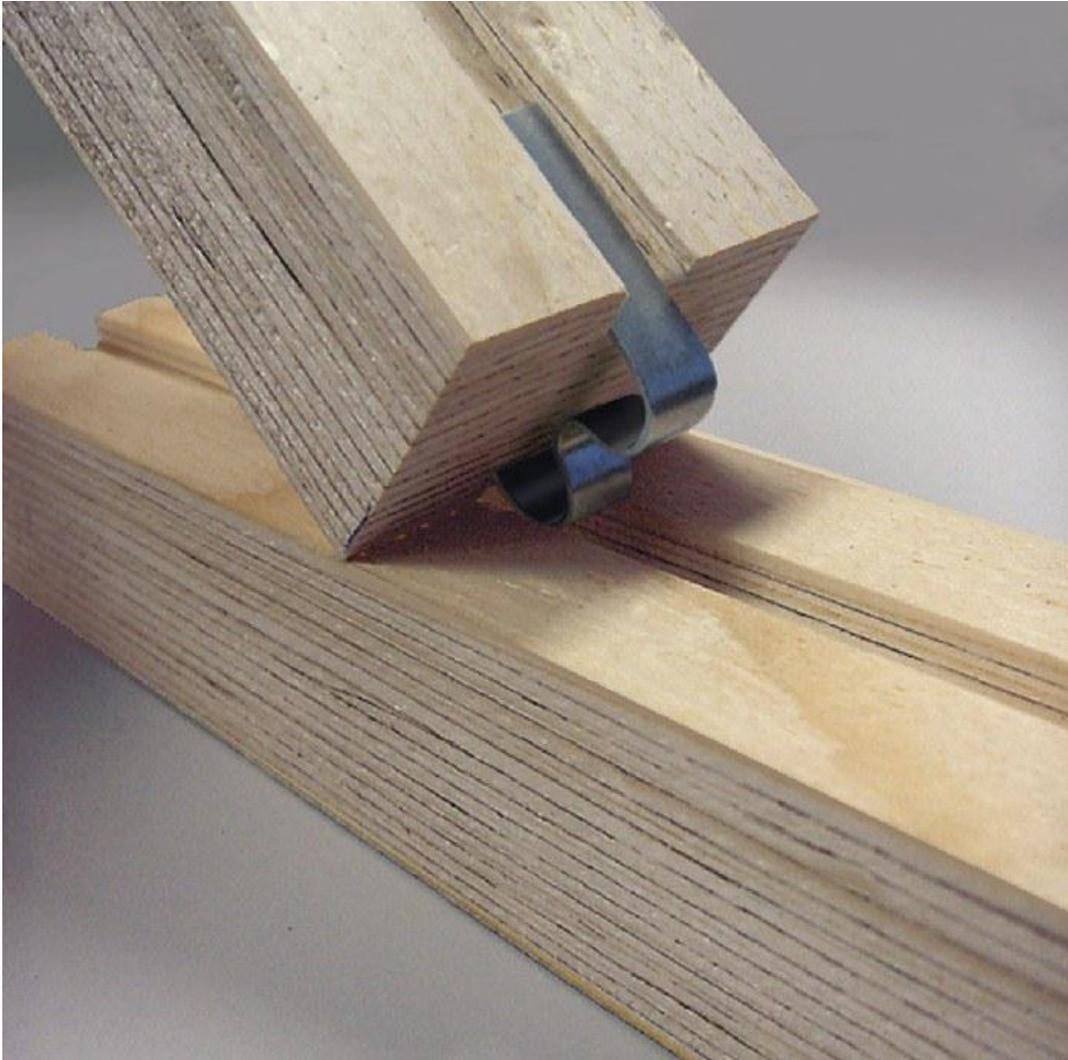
Incastro montante al traverso a pavimento. Sistema FINWALL. Immagine tratta dal sito <http://www.fh-finnholz.com/finnwall-holzstaender.html>
